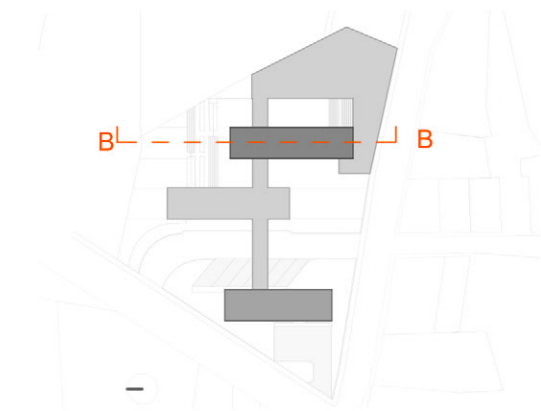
Sección Bloque B | Fuente: Elaboración propia
